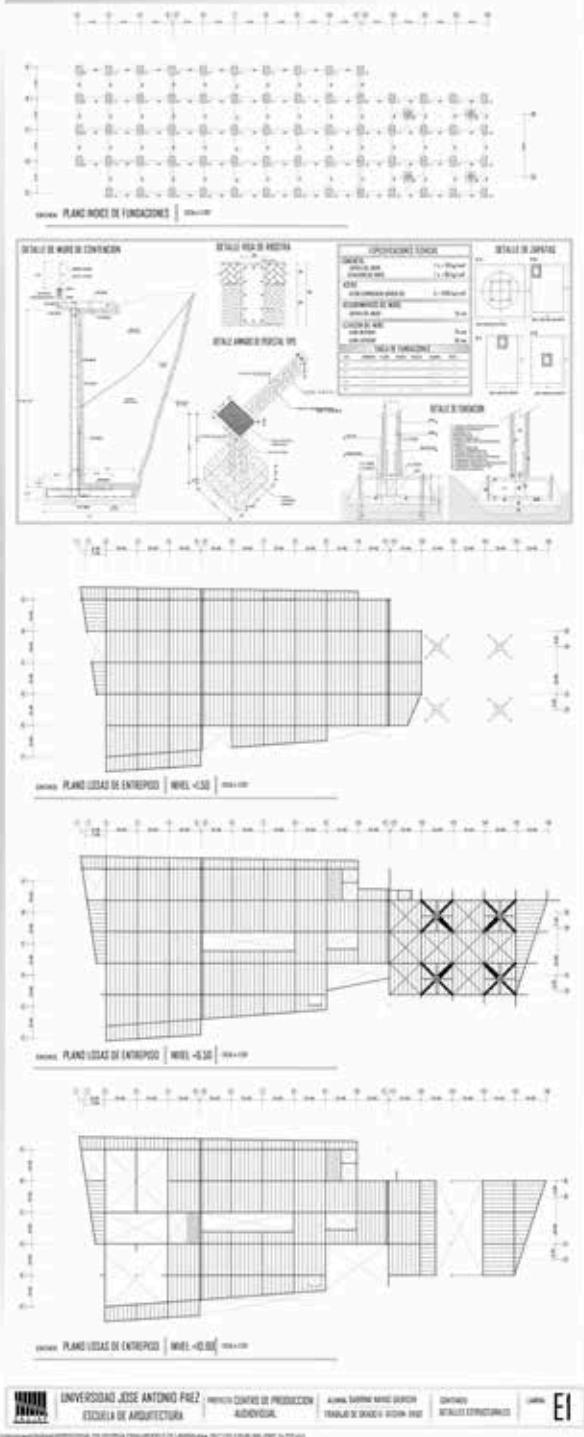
E1. Detalles Estructurales. Fuente: Navas. (2020)
